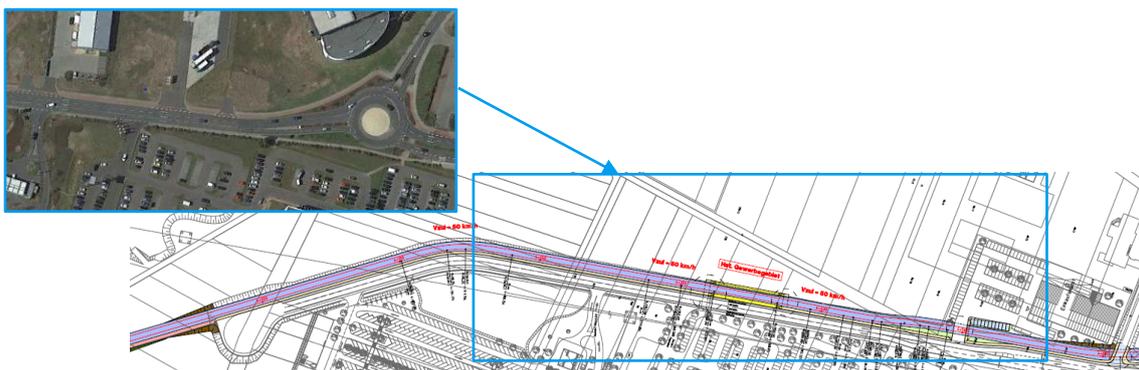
Lageplan 2006 und Situation 2018 im Gewerbegebiet West
